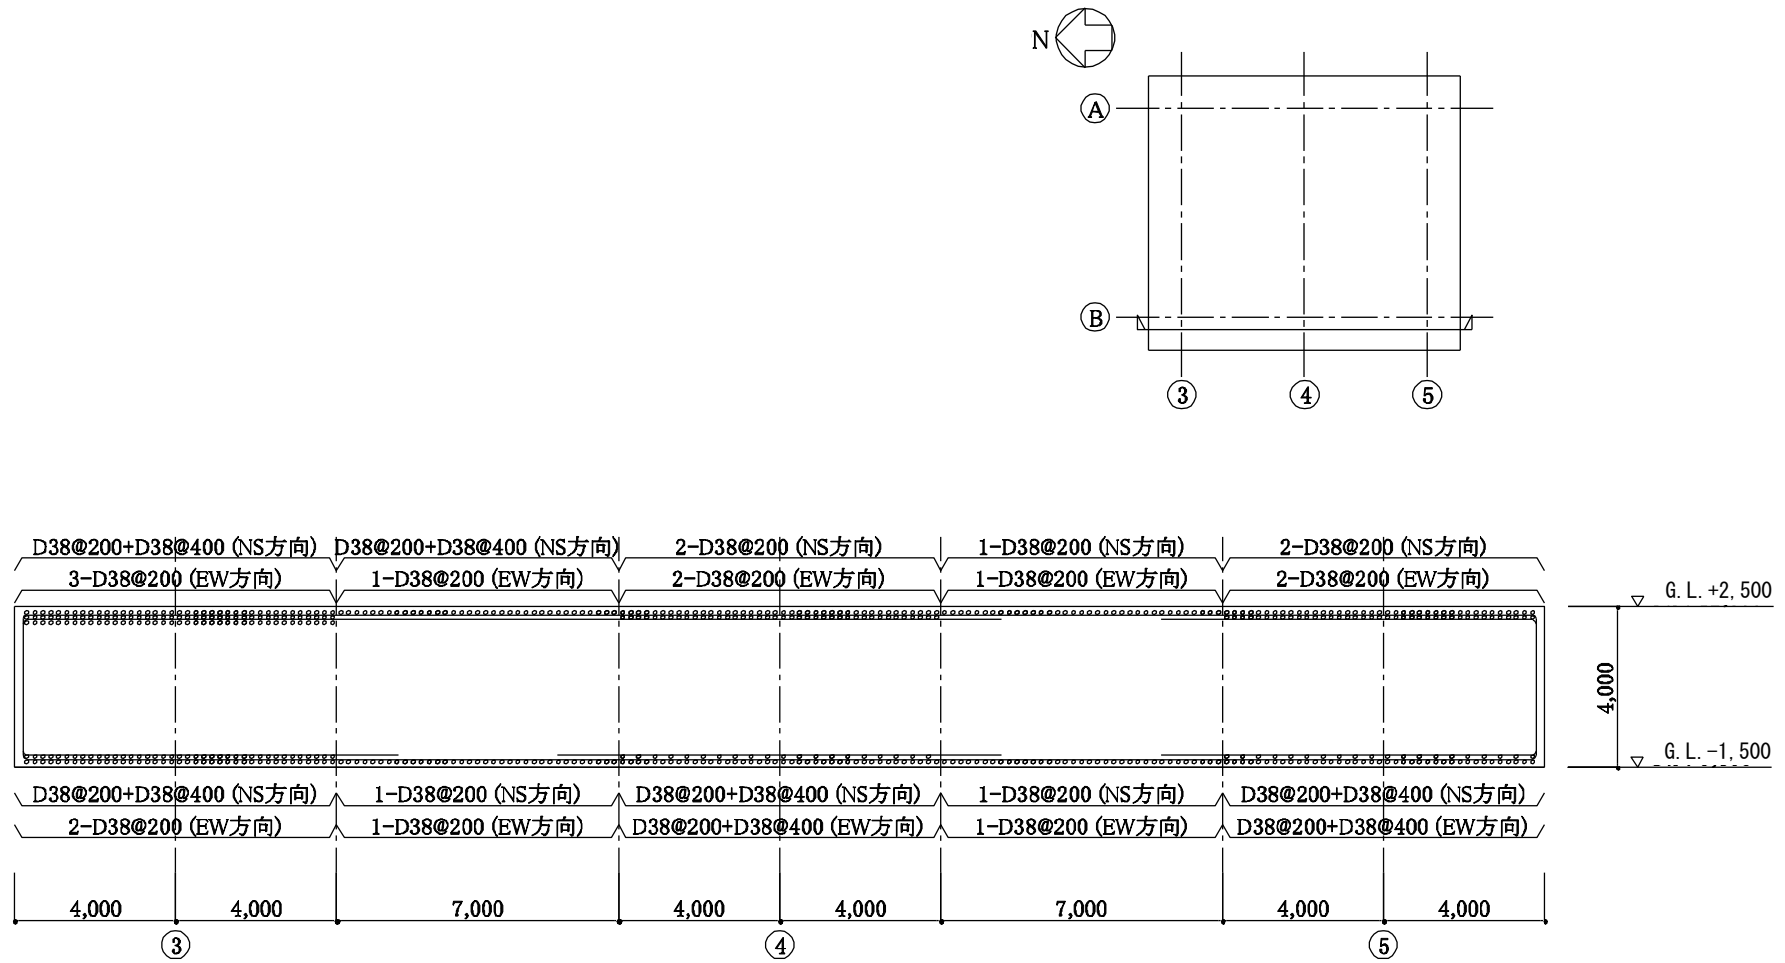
2. 1-6 基礎スラブの配筋図 (B 通り) (単位 : mm)
